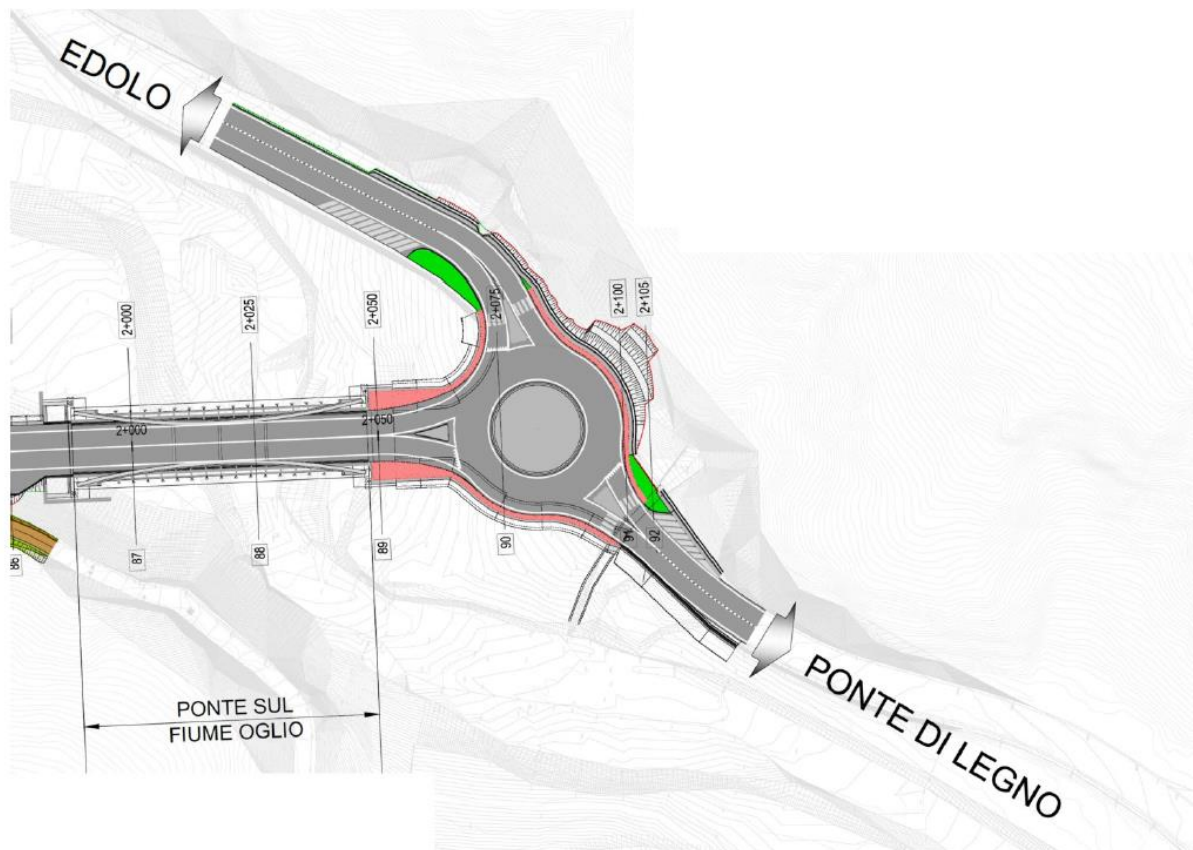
Schema planimetrico tracciato - Tratto Nord
